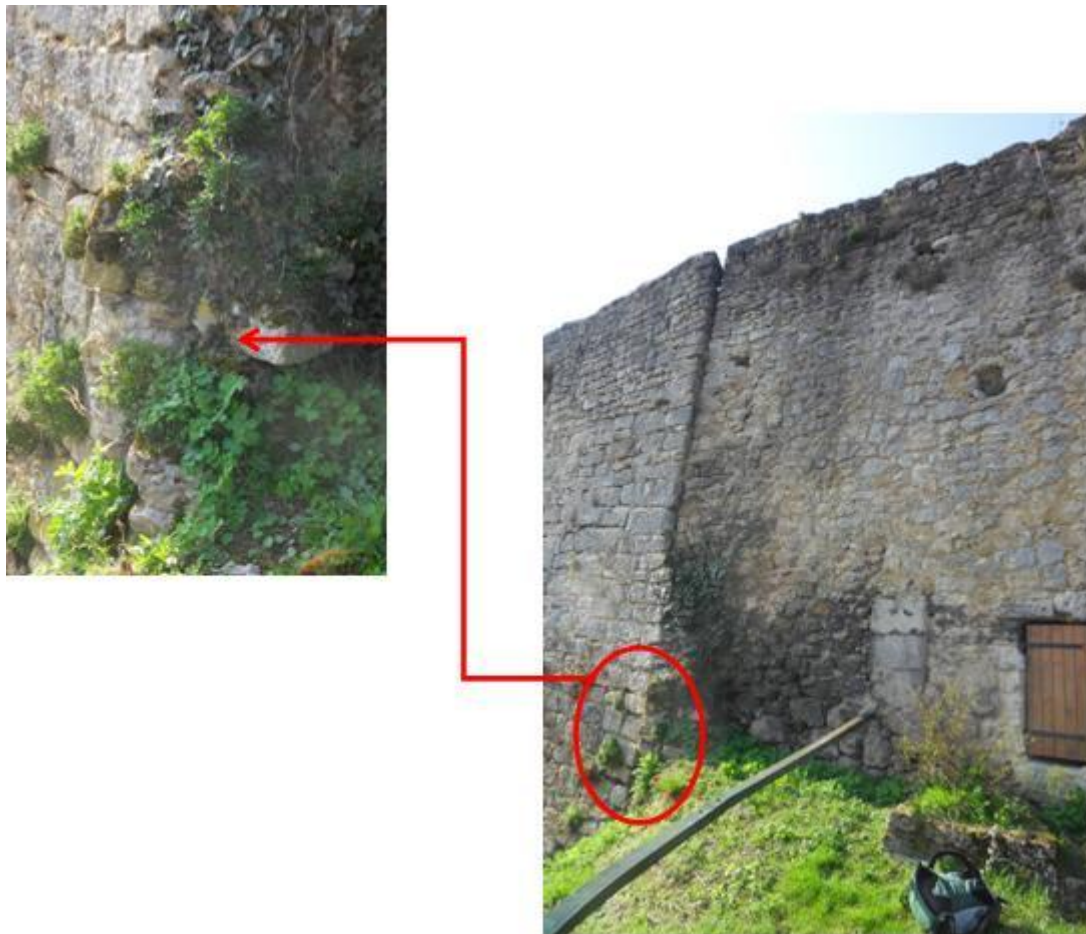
Vue sur la jointure avec la zone 2 et zoom sur les blocs instables au niveau de cette jointure.
